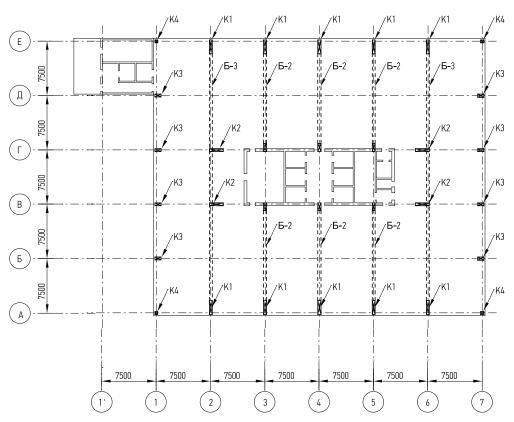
Монолитный железобетонный каркас с балочной системой перекрытия при сетке 7,5 х15 м. Маркировочный план несущих конструкций на уровнях 3-19
